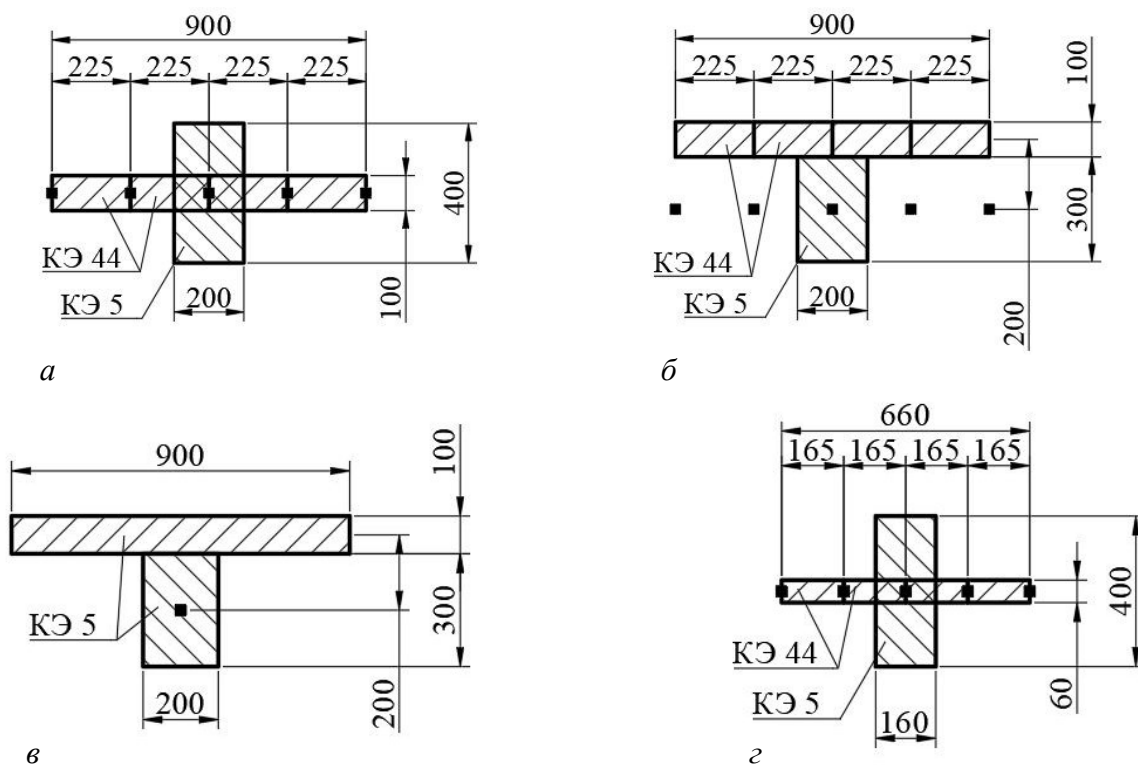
Схемы поперечных сечений балок в составе перекрытия:
